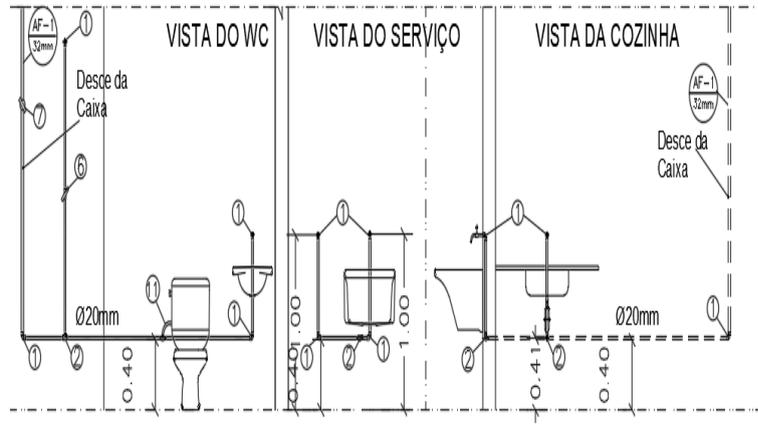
Planta baixa geral de instalação hidráulica, projeto inicial, software AutoCad
